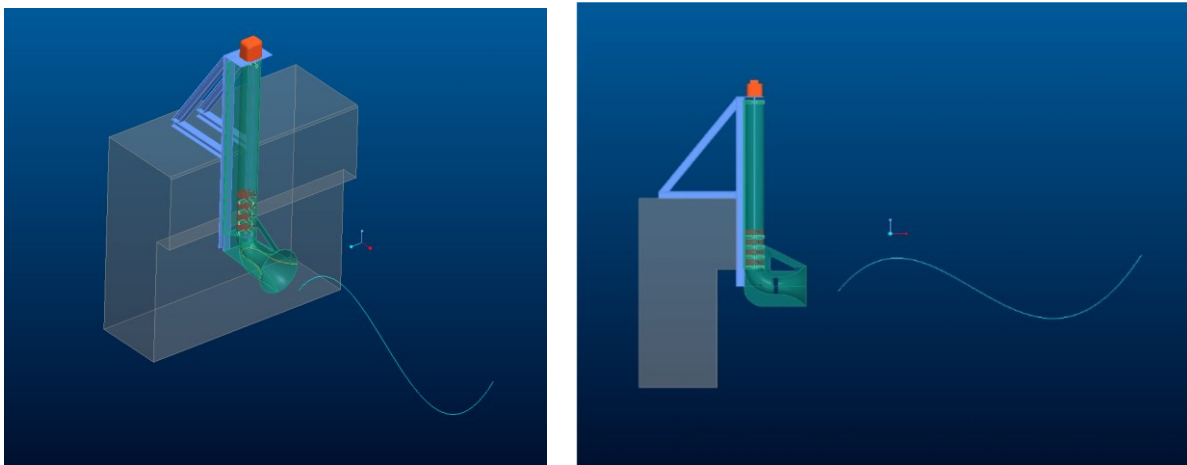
Schema d'installazione del dispositivo Wave-Sax
